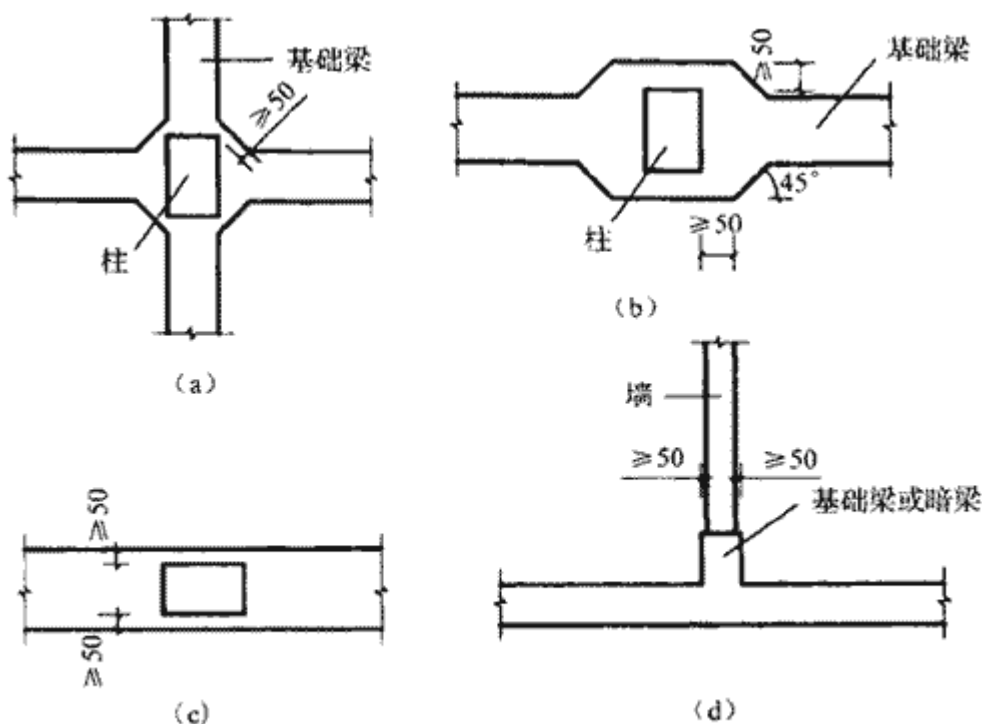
地下室底层柱或剪力墙与基础梁连接的构造要求
